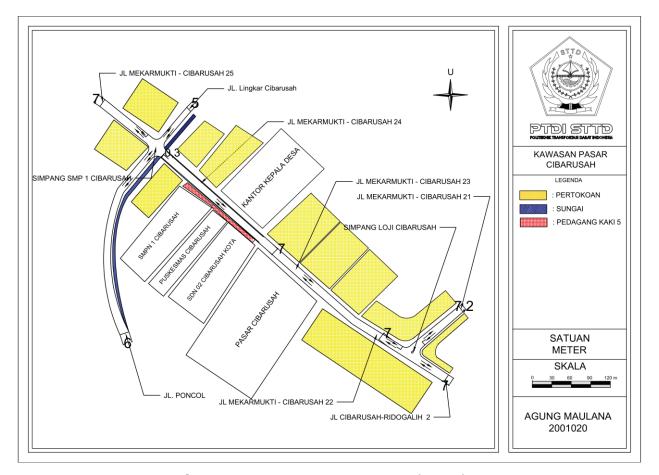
Layout Eksisting Simpang SMP 1 Cibarusah
